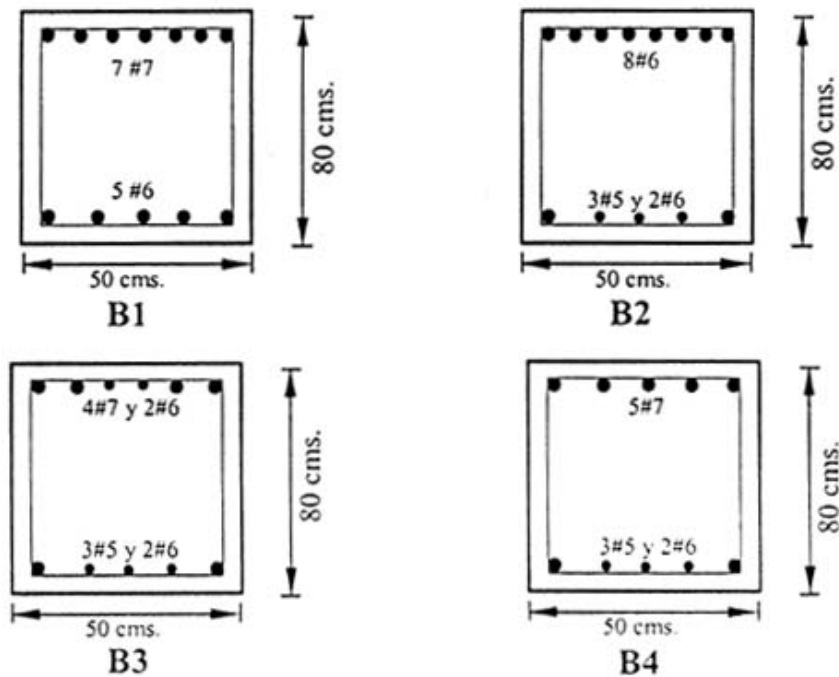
Detalles de las secciones transversales de las vigas normales.
